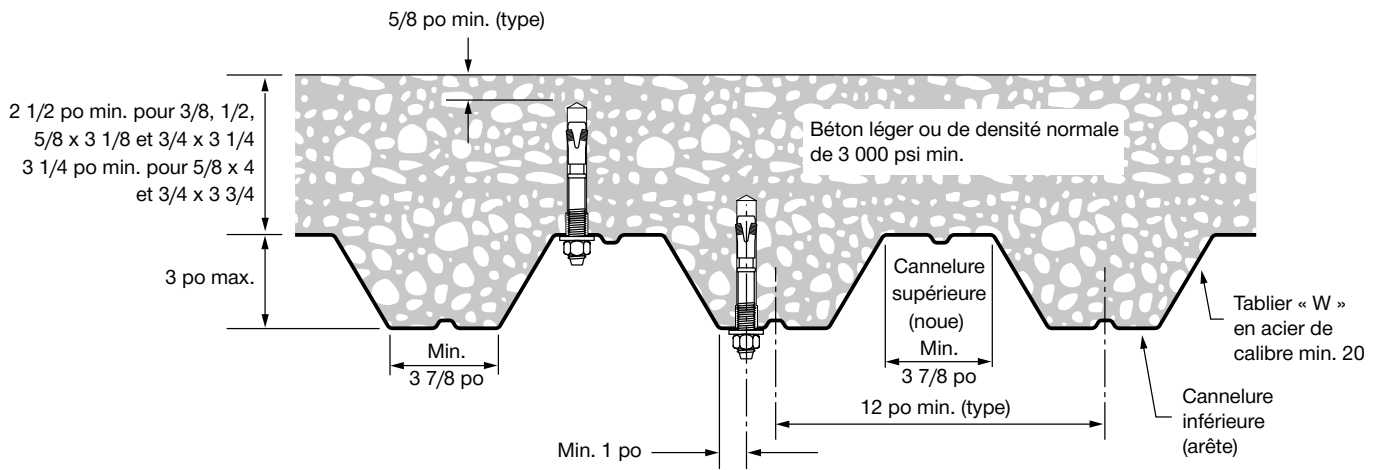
Installation d'une cheville KWIK Bolt TZ de Hilti dans le soffite d'un toit ou d'un plancher en béton sur tablier métallique – tablier « W »
